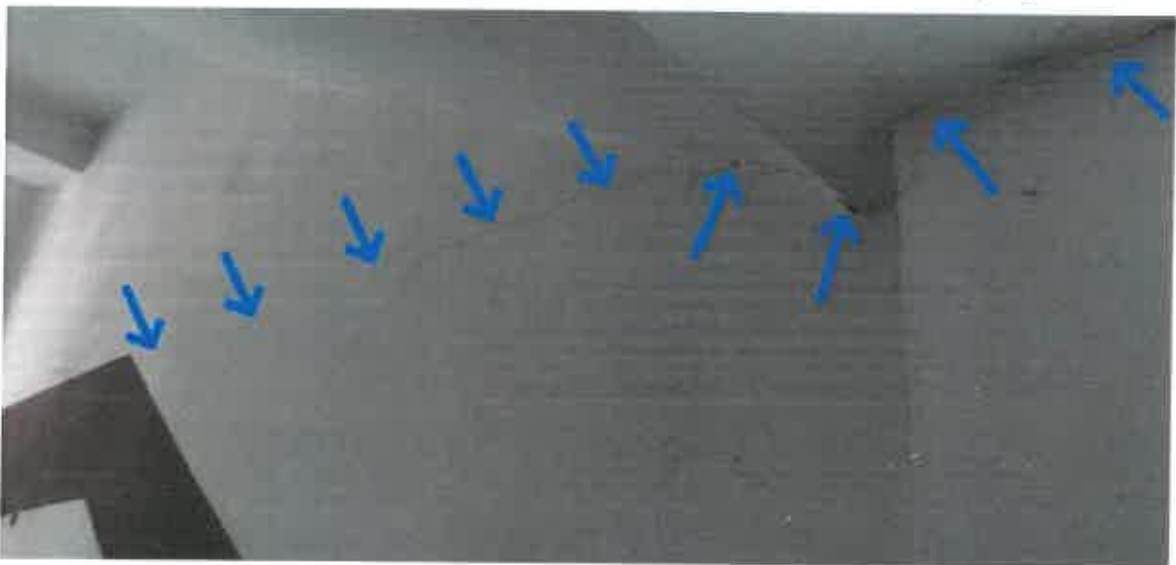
zarysowania na łączeniu konstr.i szybu windowego z pozostałymi ścianami i stropem - w klatk schod. Więzienna 30
